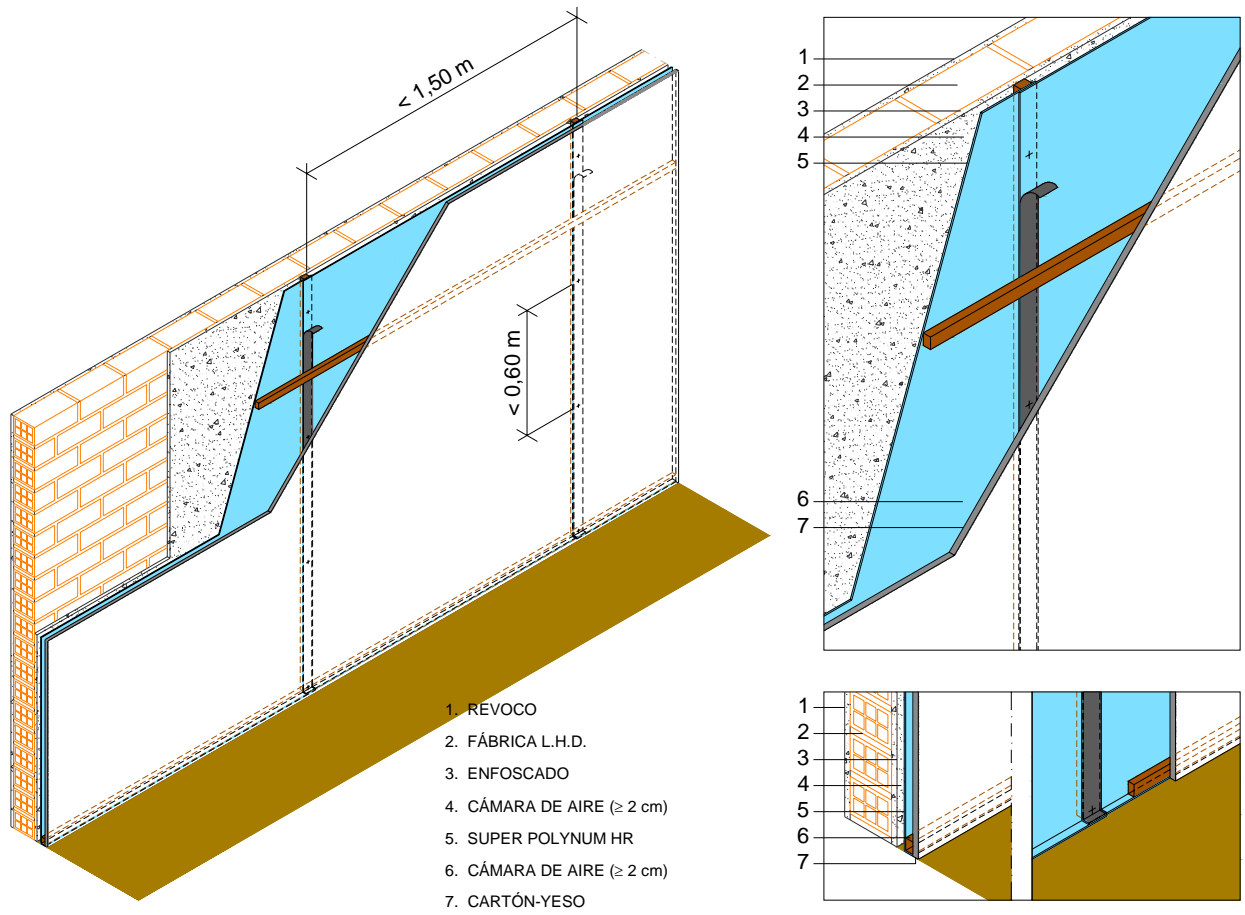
Detalle de instalación de POLYNUM 1 HR en fachada
